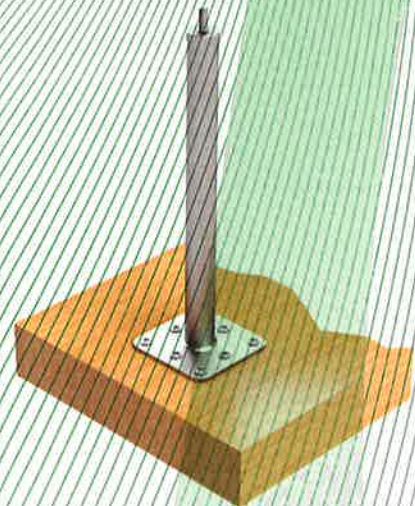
Anschlageinrichtung, Typ: SAFEX VARIANT TR-II montiert auf Vollholz
